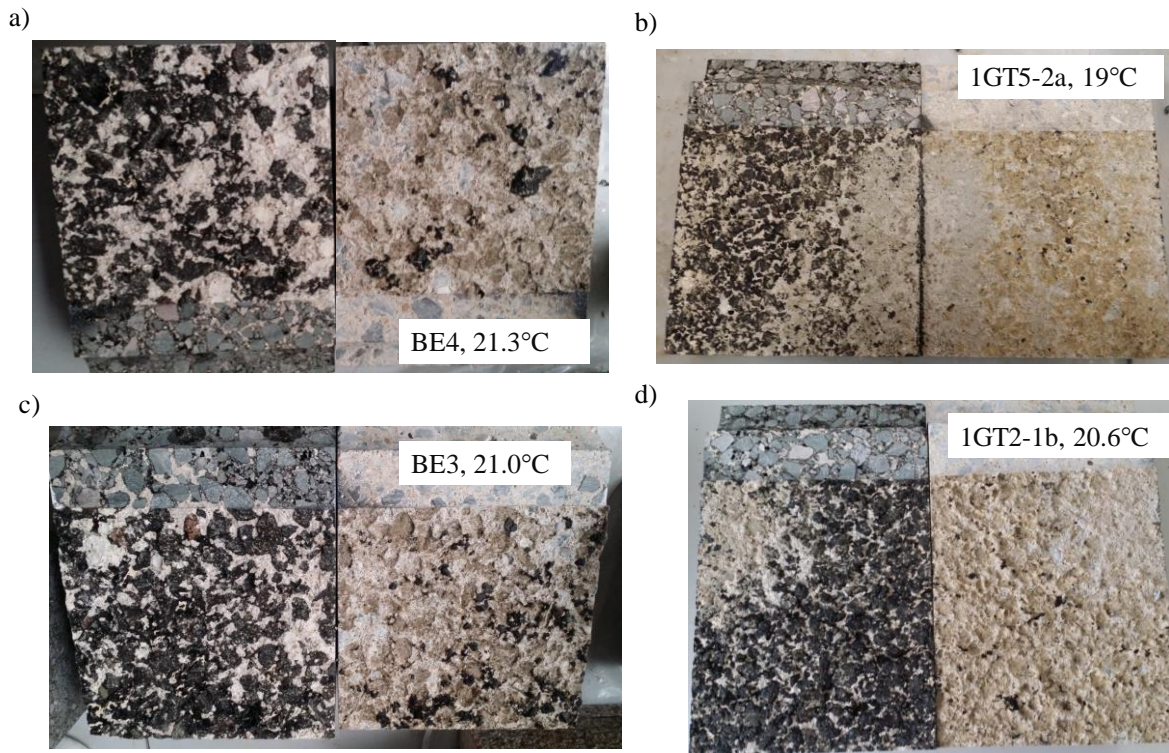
Etat de surface de rupture des interfaces des a, c) éprouvettes BE; b, d) éprouvettes 1GT (Gharbi et al., 2017b)
